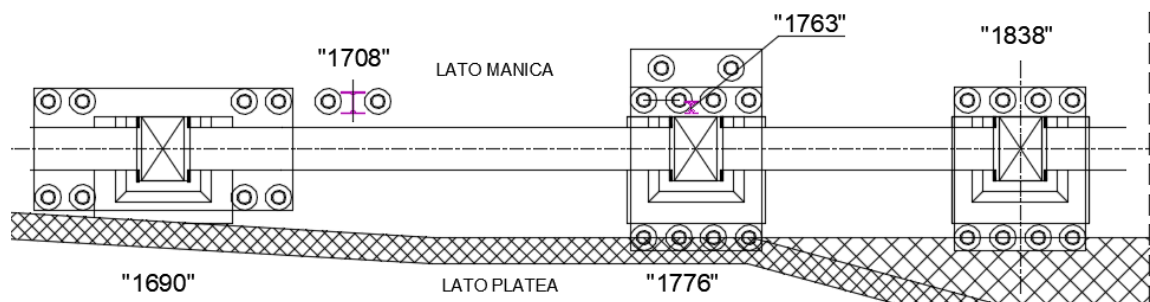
Pianta delle fondazioni su micropali IRS oggetto del presente documento
